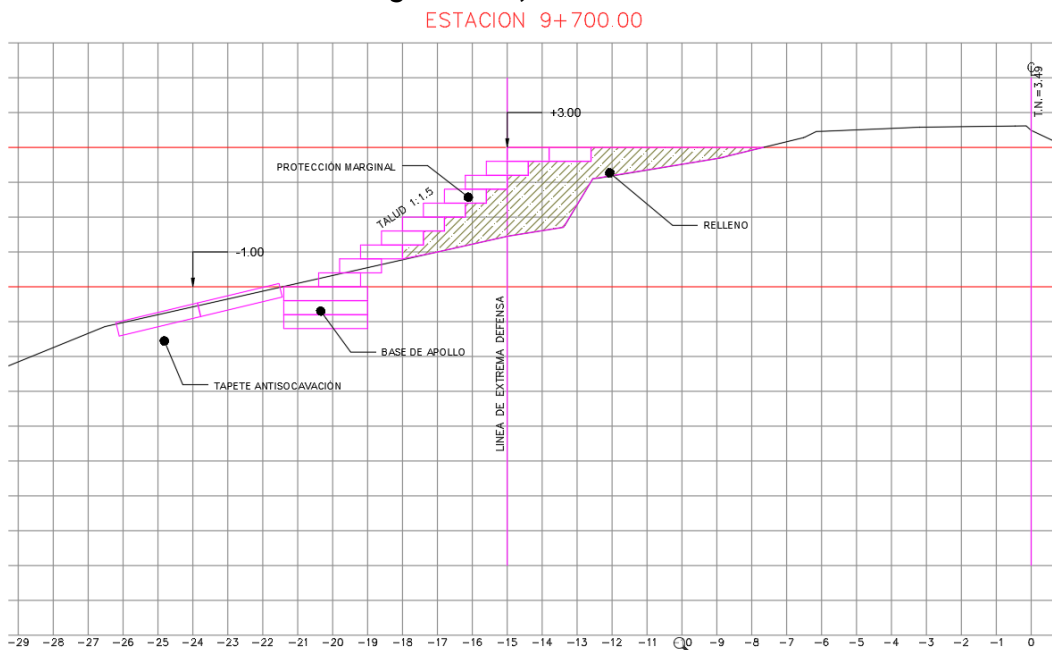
Perfil tipo de tramos donde se requiere de protección a nivel de margen actual, Alternativa 02.
